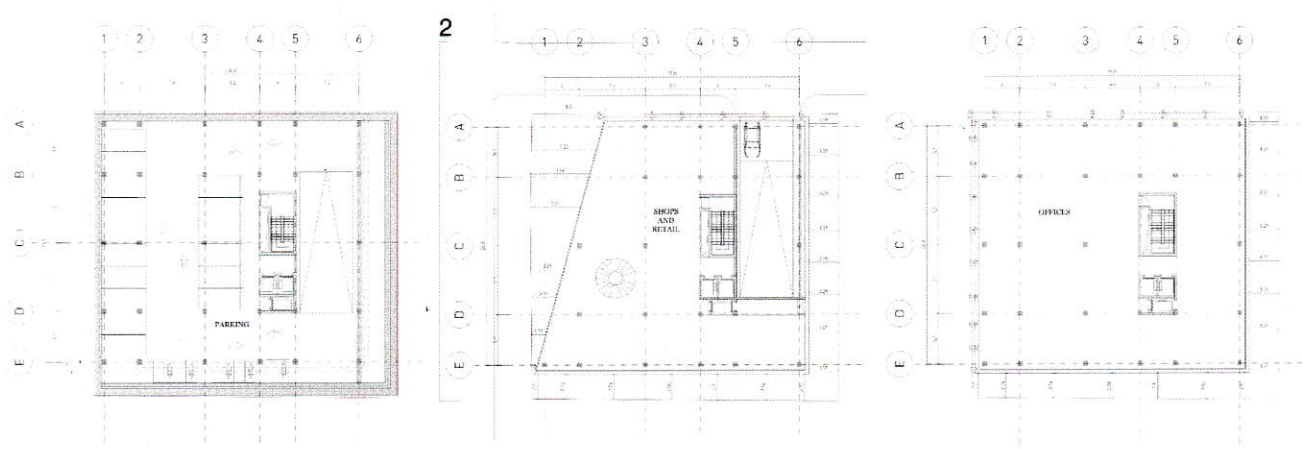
planet tip te: parkimeve, kati i biznesit dhe kai i zyrave
